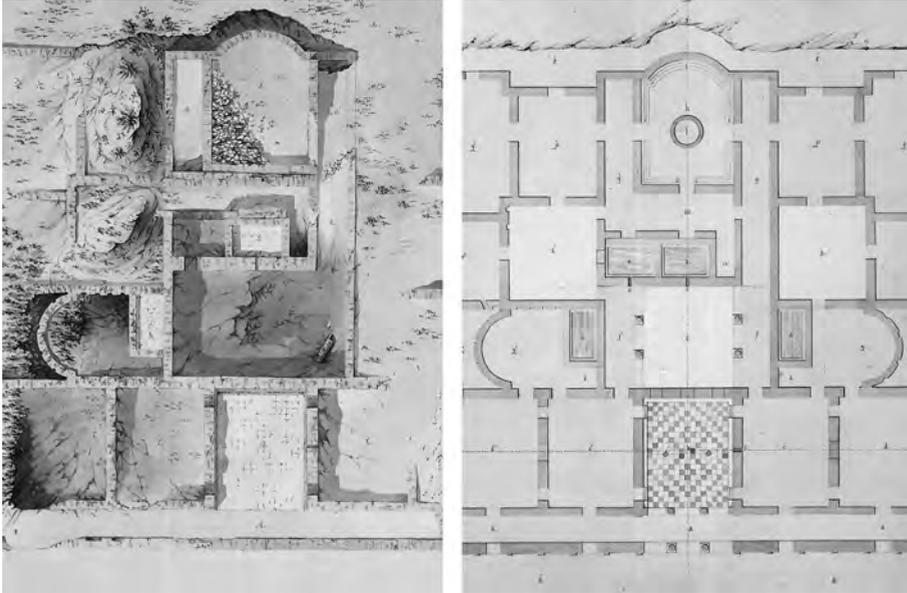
Plano de trabajo y reconstrucción ideal del conjunto termal de D. Ríos (de: Fernández Gómez, 1998, 147 y 149).
